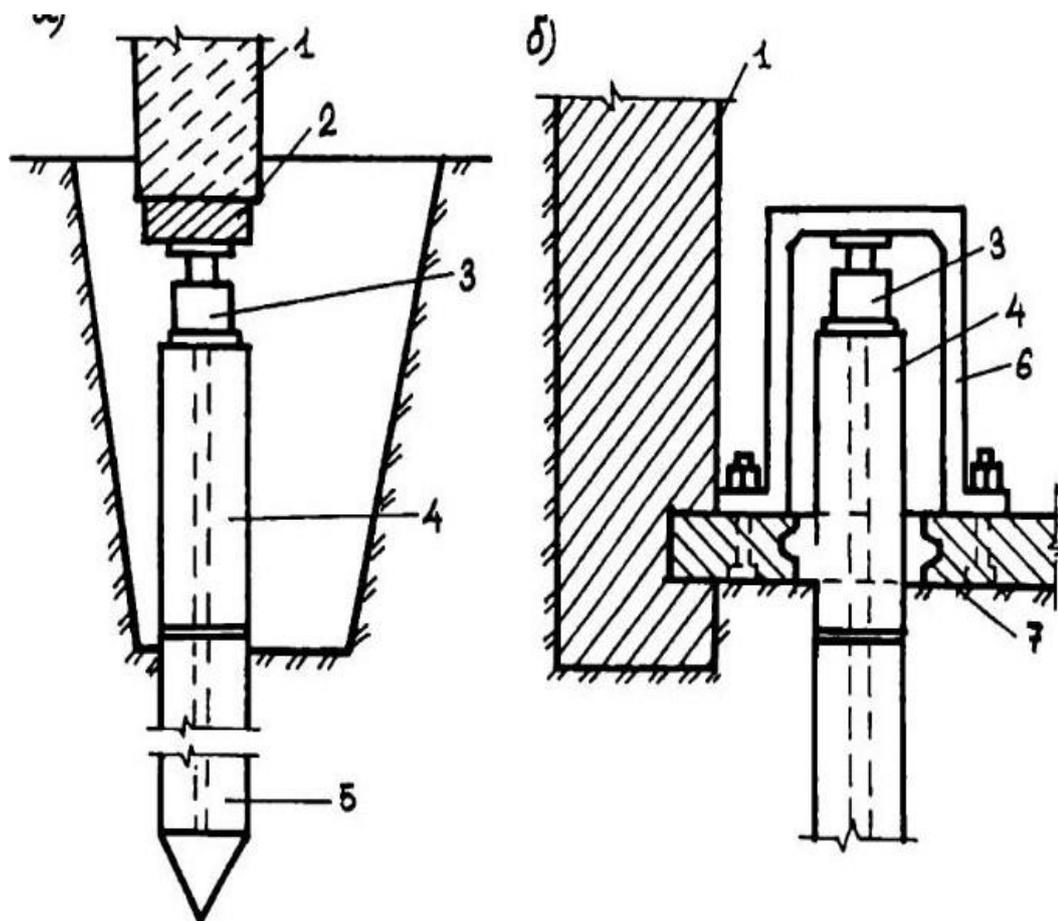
Схема вдавливания свай типа Мега (а – при расположении свай под стеной или фундаментом; б – при расположении свай рядом с фундаментом): 1 – стена или фундамент; 2 – выравнивающая стальная или железобетонная балка; 3 – домкрат; 4 – промежуточный элемент свай; 5 – первый элемент свай; б – упорная конструкция; 7 – железобетонная плита с окнами для свай
